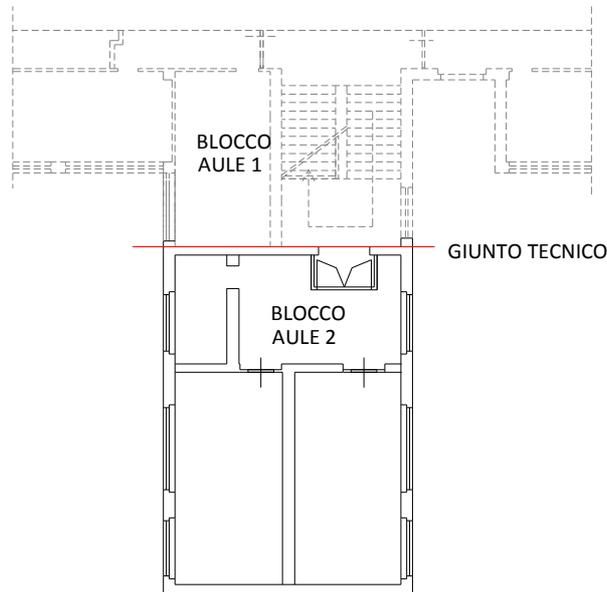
8: Blocco aule 2, pianta tipo con indicazione del giunto di separazione dal blocco aule 1.
